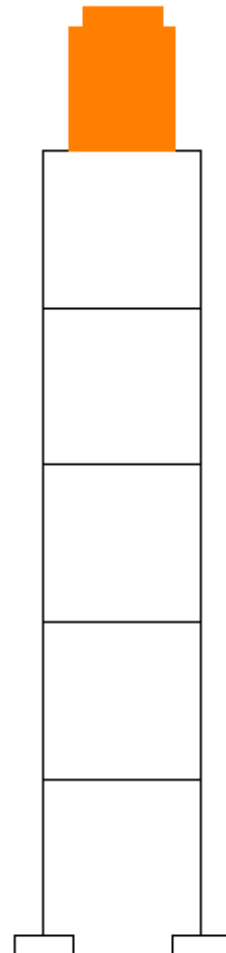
, 5 dan 6 memperlihatkan denah plat. Terdapat balok anak pada tengah bentang. Ukuran bentang 3 m untuk antar kolom. Dengan balok anak balok 1,5 m. Sedangkan Gambar 7 dan 8 memperlihatkan tampak samping dan depan struktur menara air tersebut.
